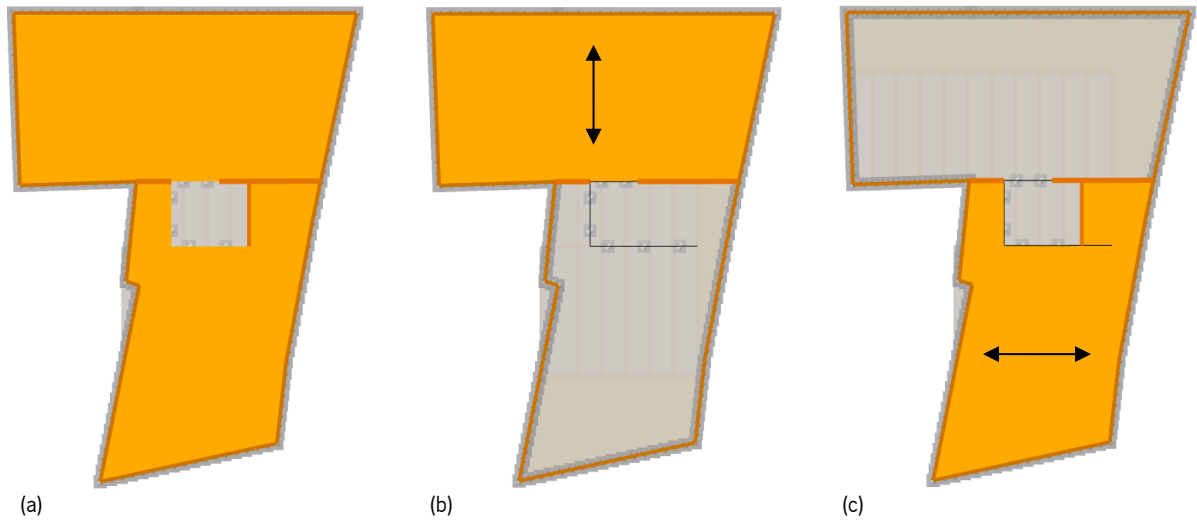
Orientação dos painéis CLT de piso. (a) Pavimento completo; (b) Orientação dos painéis da zona frontal do edifício; (c) Orientação dos painéis da zona posterior do edifício
